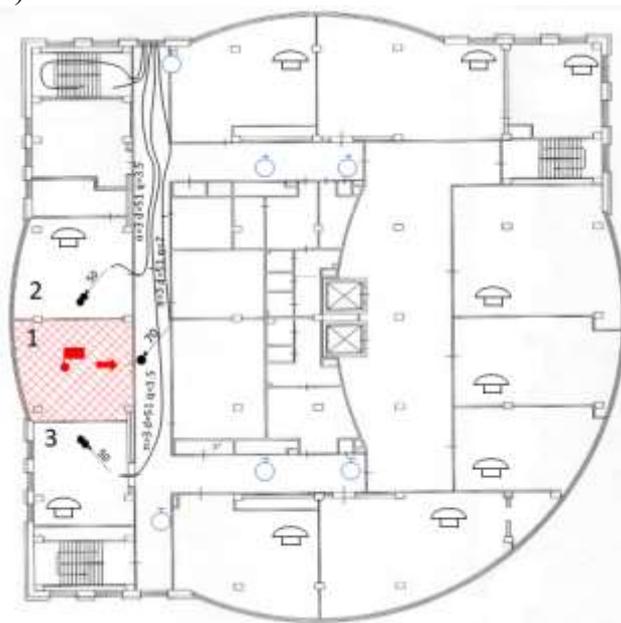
Схема подачи стволов на тушение пожара и защиту смежного помещения на 5 этаже
